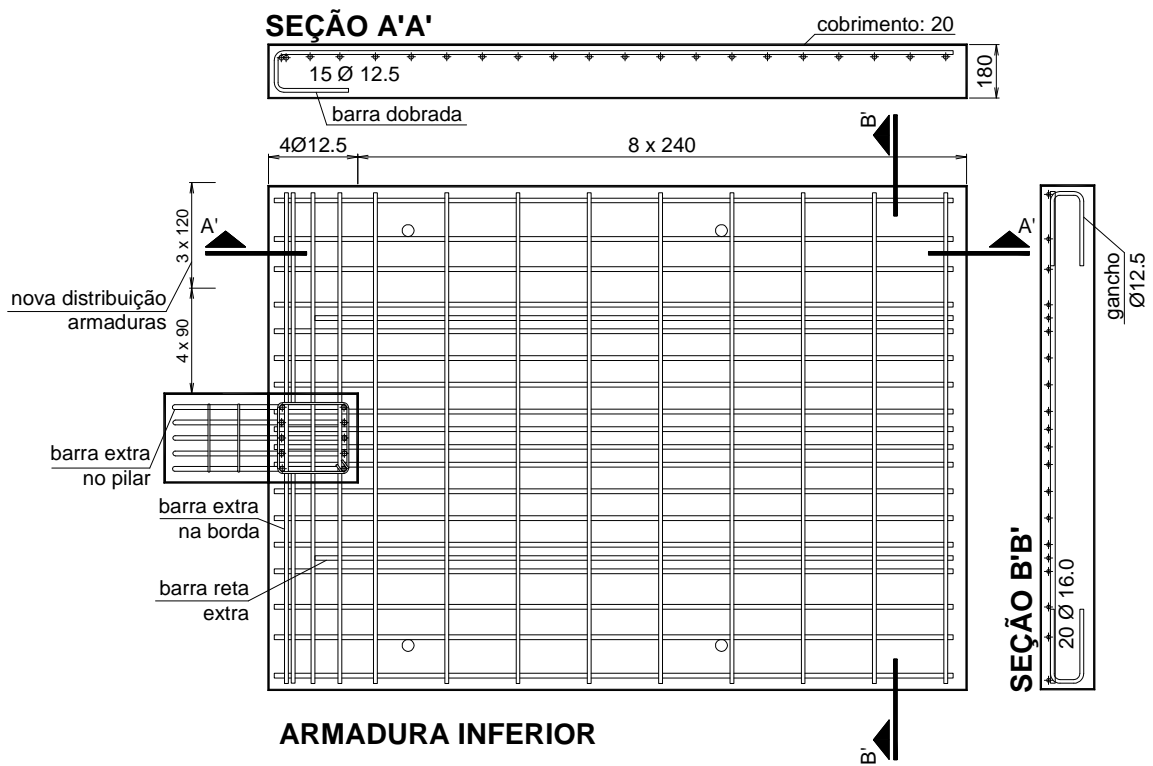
Modificação da distribuição da armadura inferior e do pilar (L7, L10-L13)
